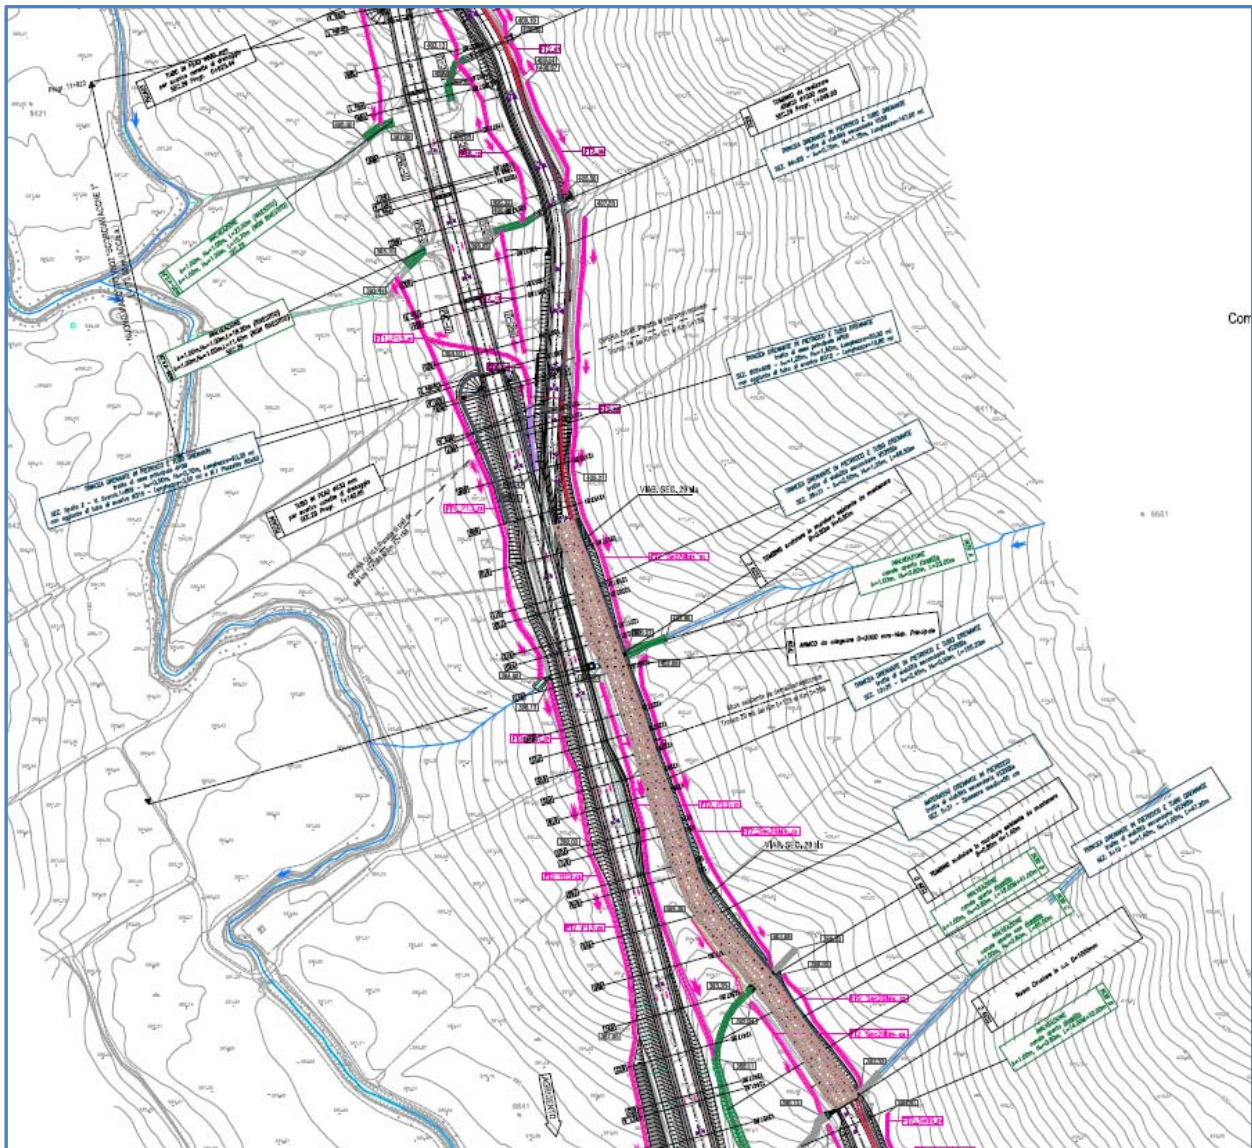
Stralcio planimetrico con l'ubicazione dei tombini idraulici TS29D e TS29E.
